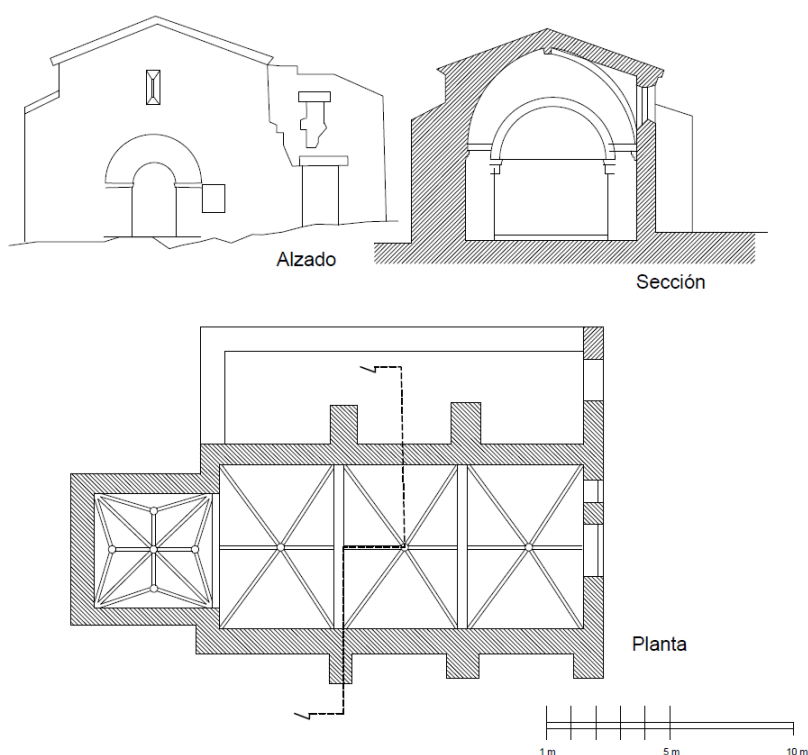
Dibujos del alzado, sección y planta de la Ermita.
